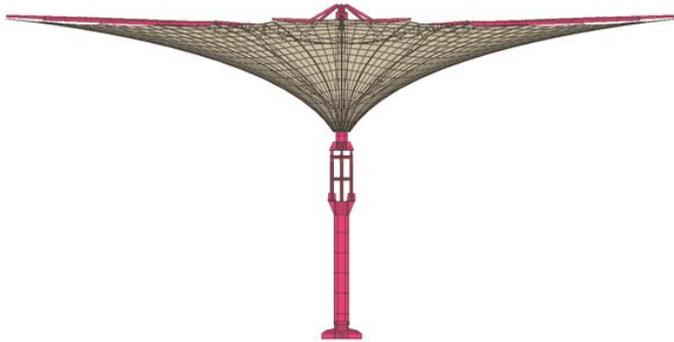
Cubierta alabiada, Piazza roofing of the prophet's mosque, medina, sa, 2010 Recuperado de <https://bit.ly/2Zs7Mci>
